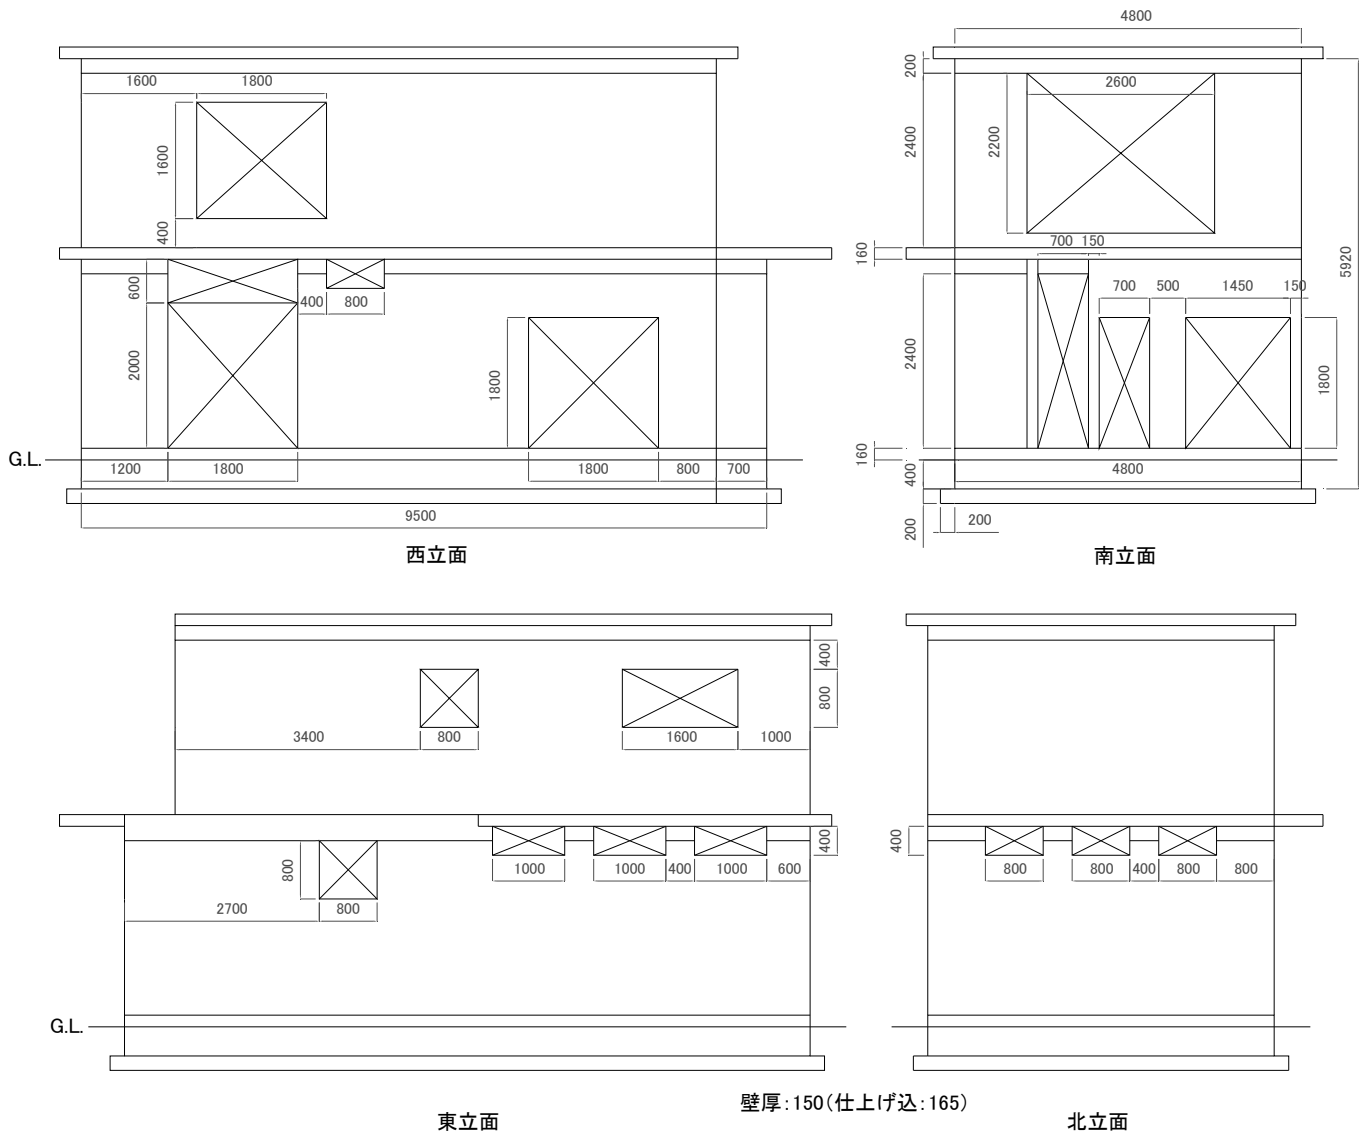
CB造2階建て住宅の立面図 (単位: mm)
